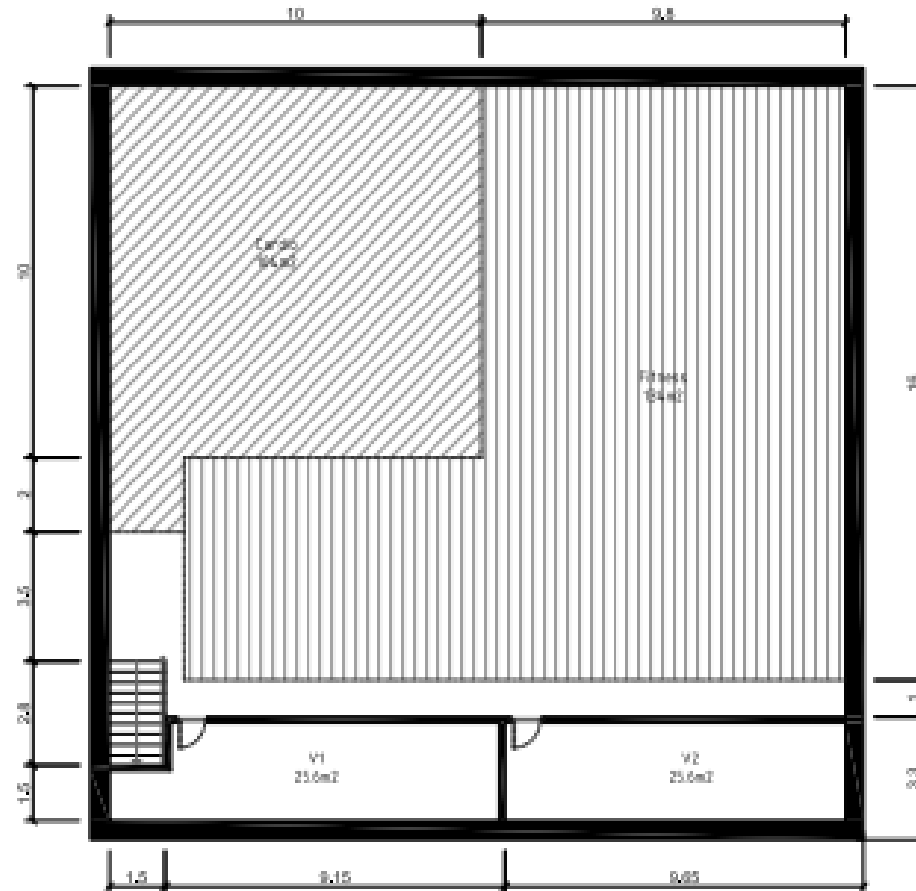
Plano planta baja. <<Fuente. Elaboración propia>>
